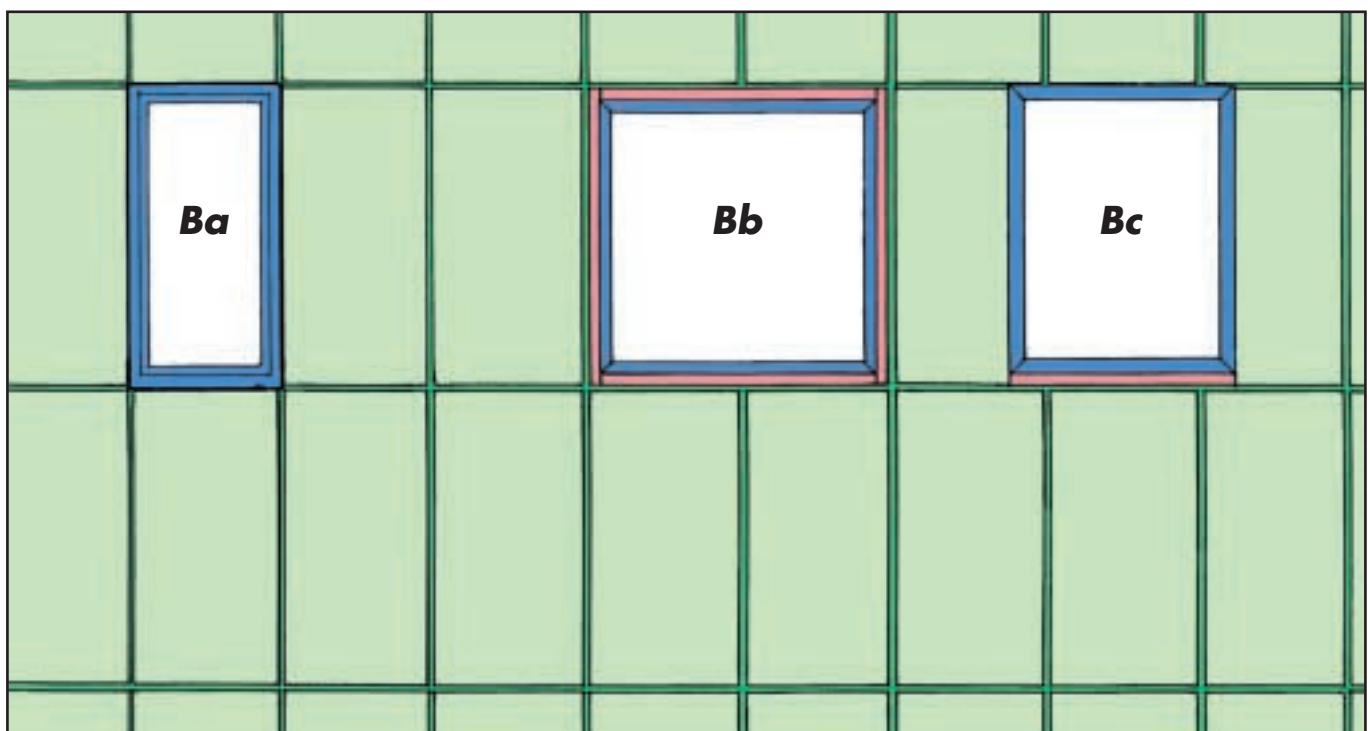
b) - Posizione delle finestre nel reticolo architettonico della facciata
